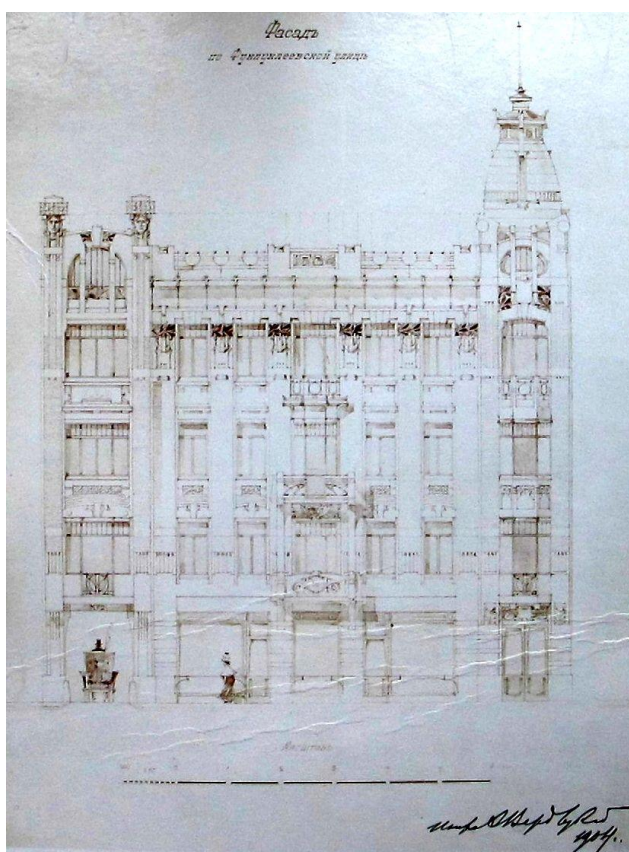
Проектне креслення фасаду будинку на вул, Богдана Хмельницького,
